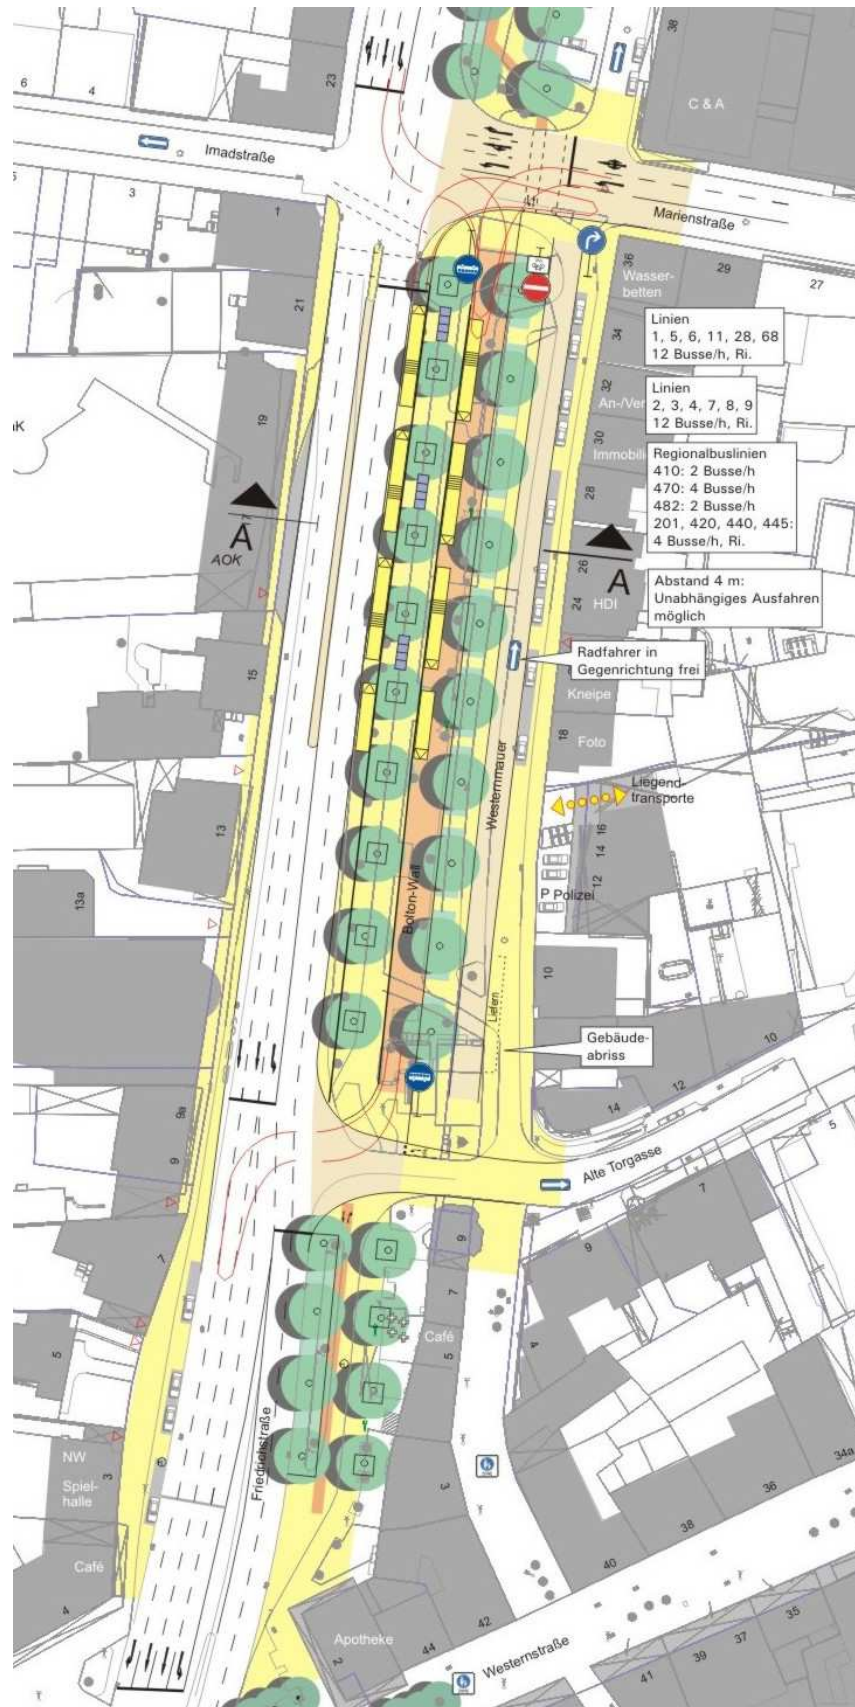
Variante 3 (Busfahrgasse und Haltestelle innerhalb der Allee) der ZOH Westernmauer im Lageplan
